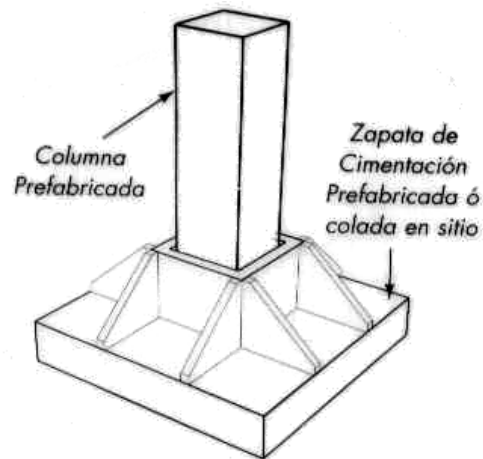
Apoyo de columna en cimentación (2)
